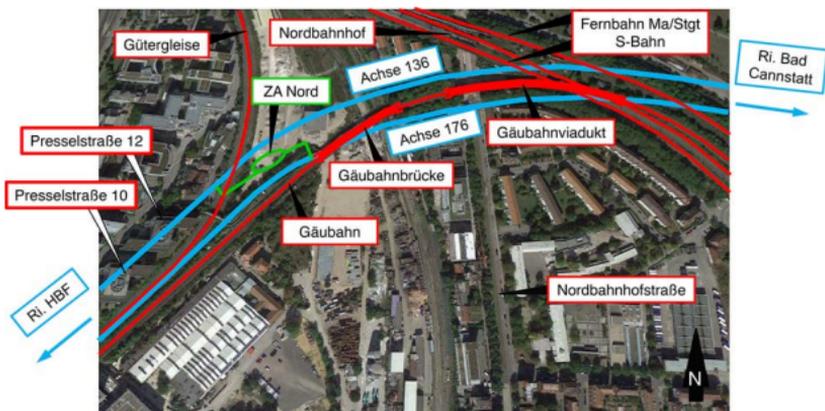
Unterfahrung Bahnanlagen und Gebäude, Tunnel nach Bad Cannstatt
